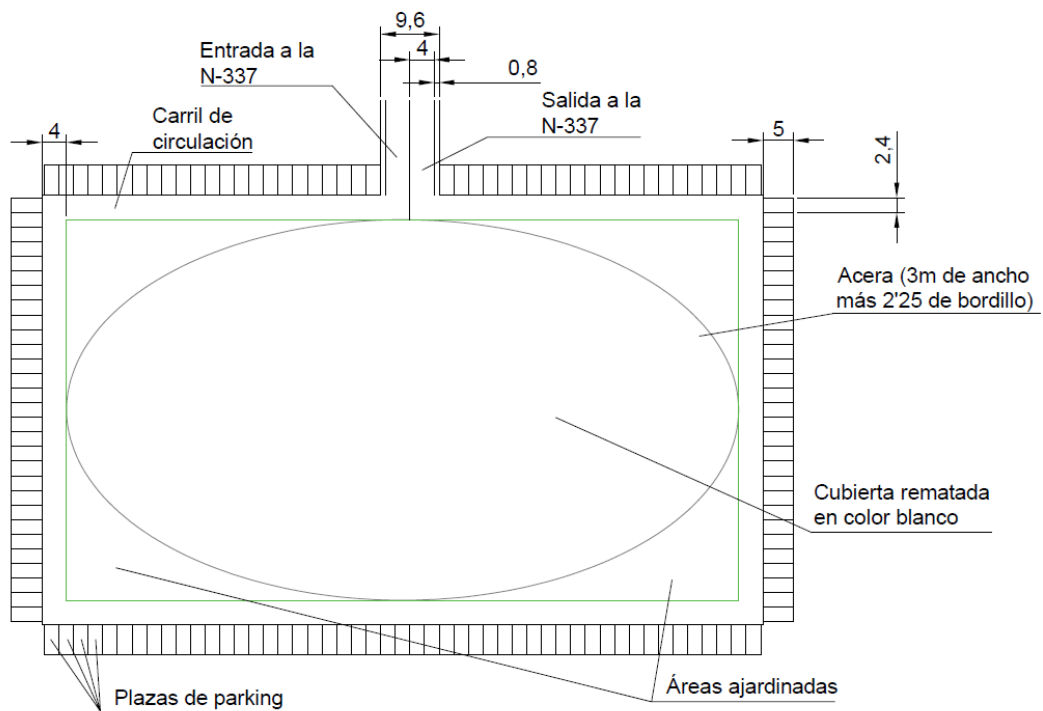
Esquema en planta del parking para usuarios. Fuente propia.
